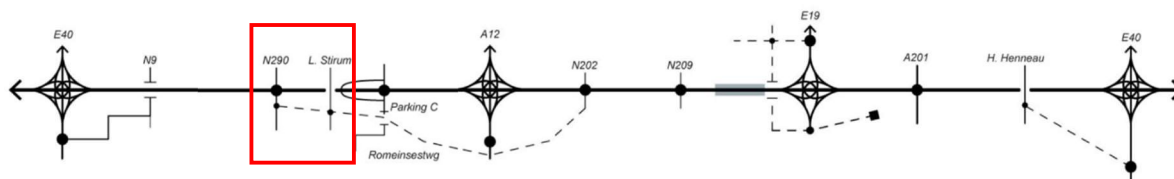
Schéma linéaire G1A1 variante profil longitudinal réduit/pont paysager maximal Wommel-Jette (depuis la N290 à l'Avenue De Limburg Stirum)
